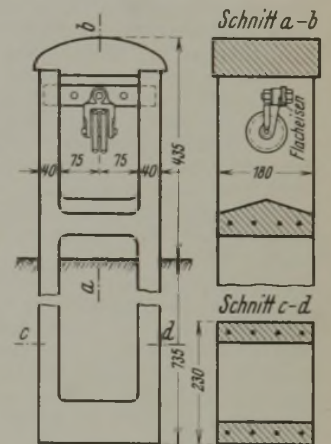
Betonständer für 1 bis 2 Leitungen. (Bauart Roudolf.)
